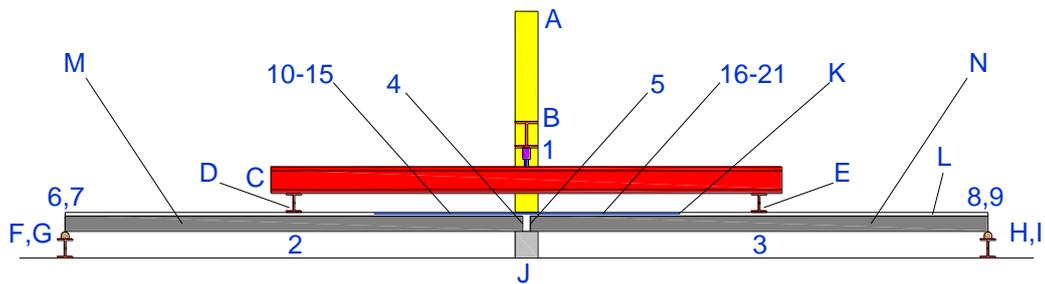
Esquema de ensaio de flexão em lajes alveolares com continuidade.
